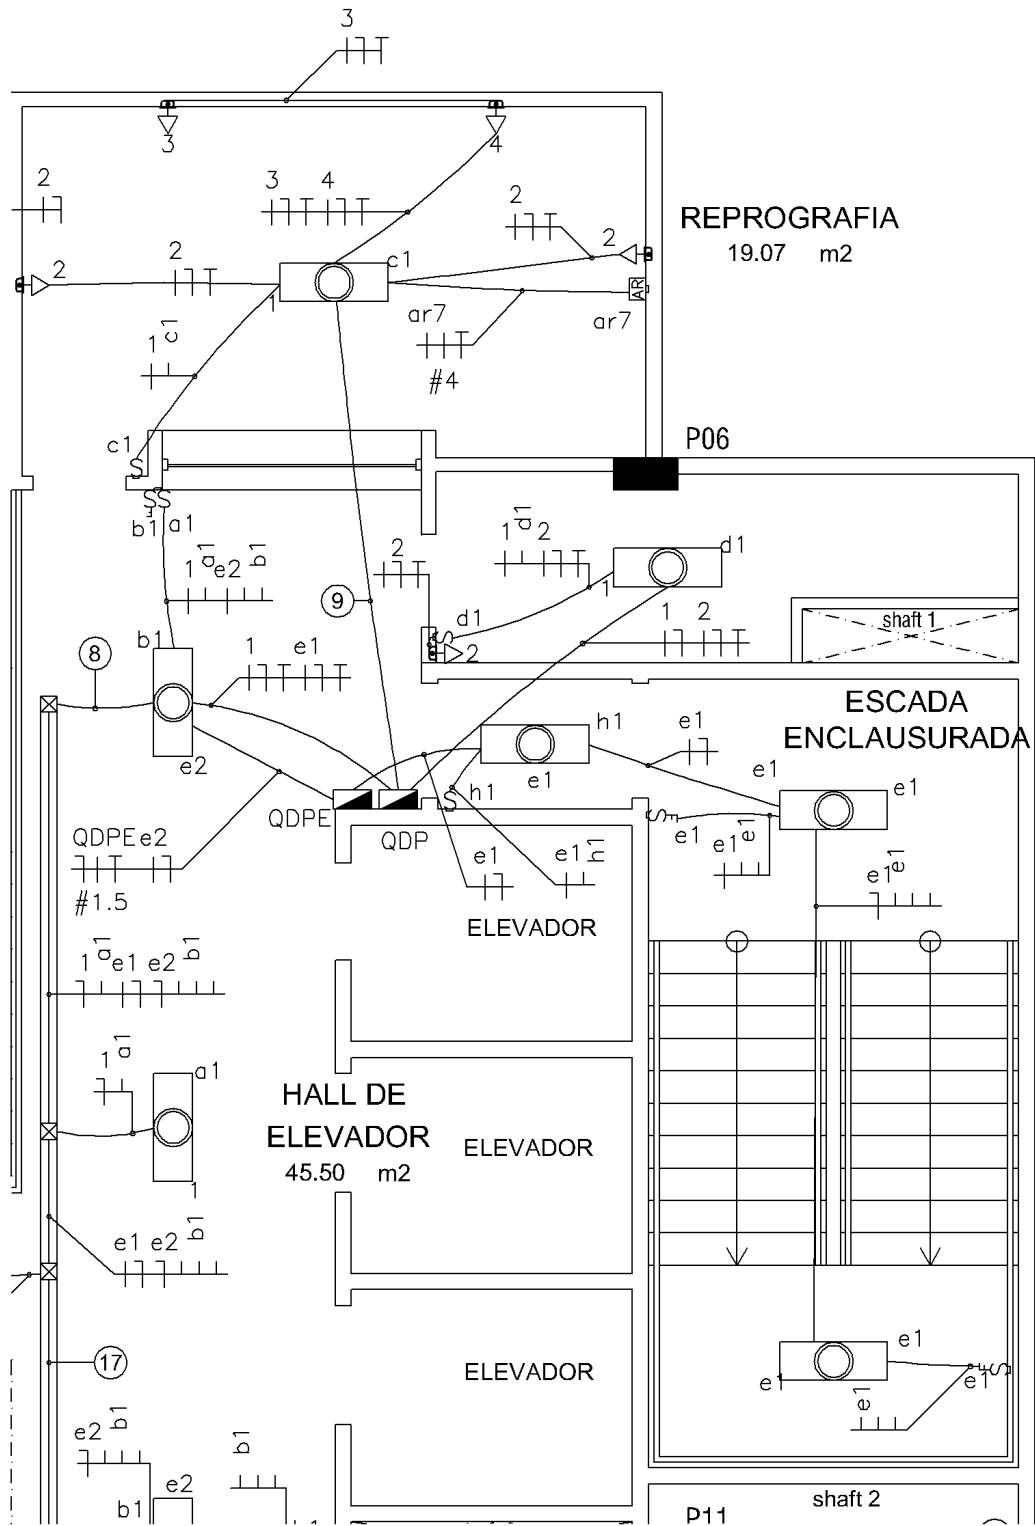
Planta baixa projeto elétrico do 2º pavimento do ICS (Continuação).
